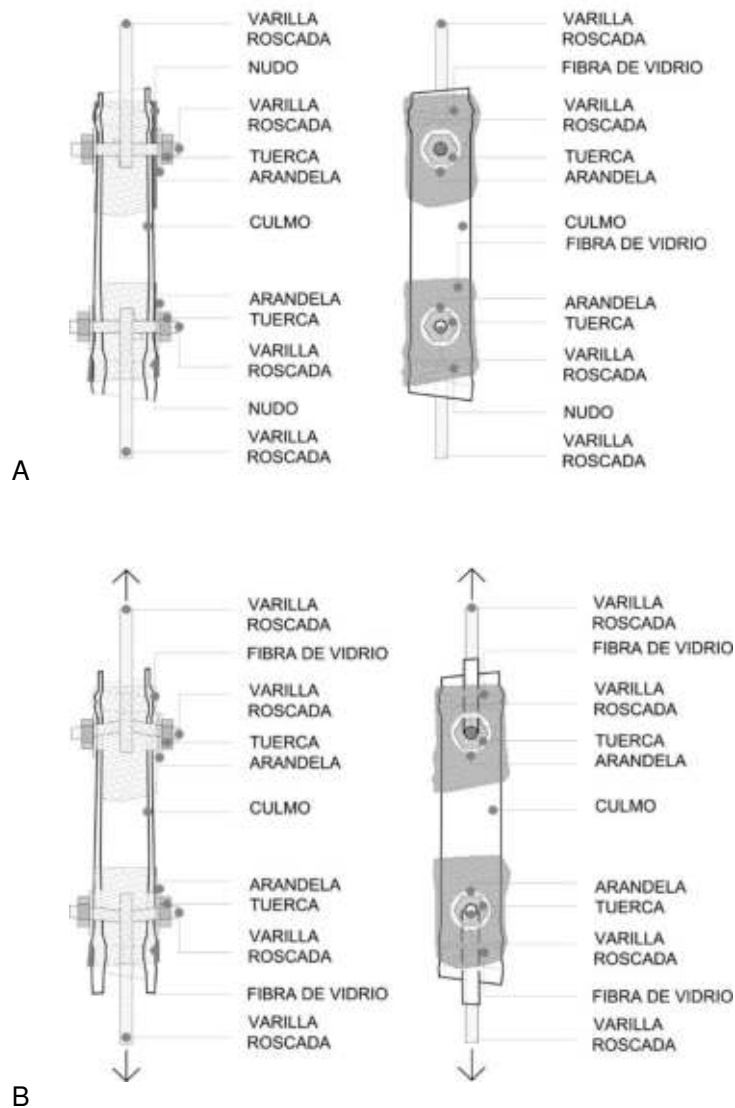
Detalle constructivo de dispositivo 5. a) Situación inicial de dispositivo 5, b) Situación final con varilla deformada luego de esfuerzo de tracción de 365kg.
